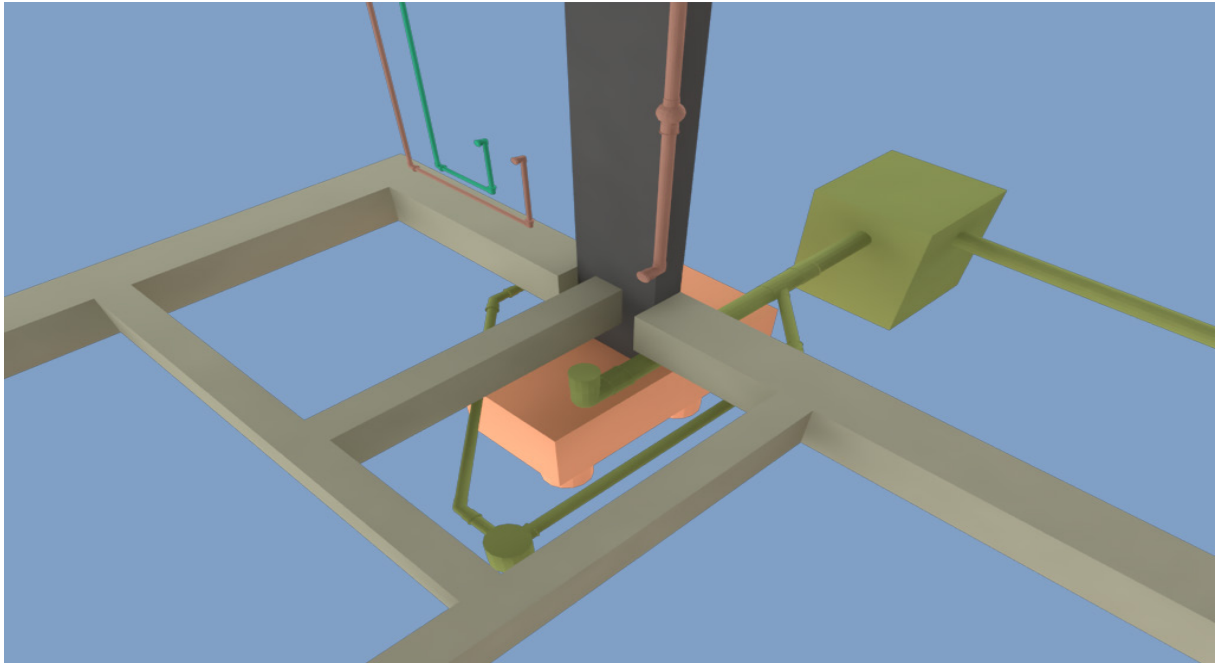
Visualização tridimensional do lançamento hidrossanitário do Lavabo - Vista 2
